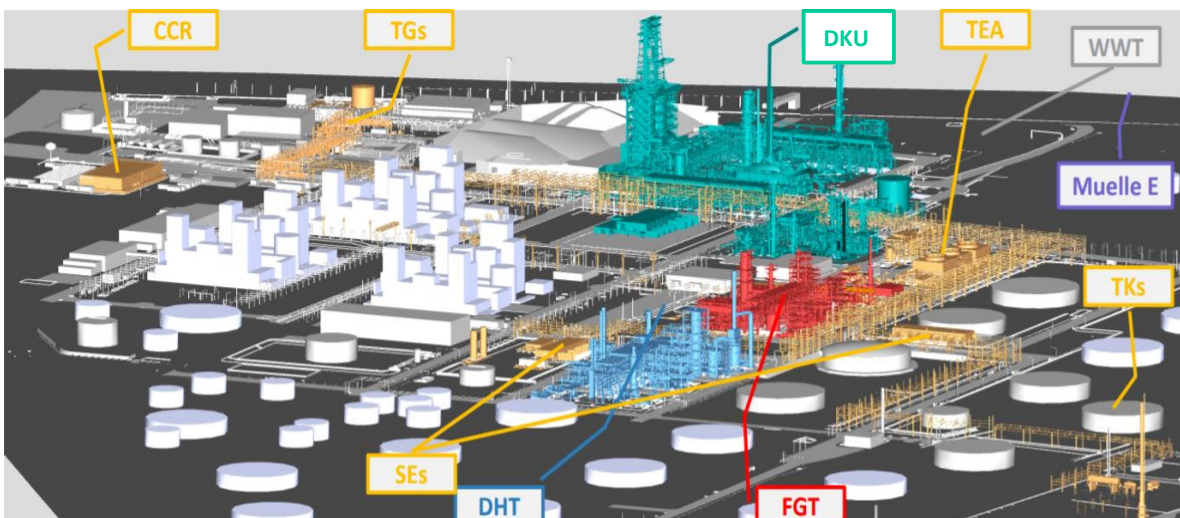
VISTA PANORAMICA DE NUEVAS PLANTAS
